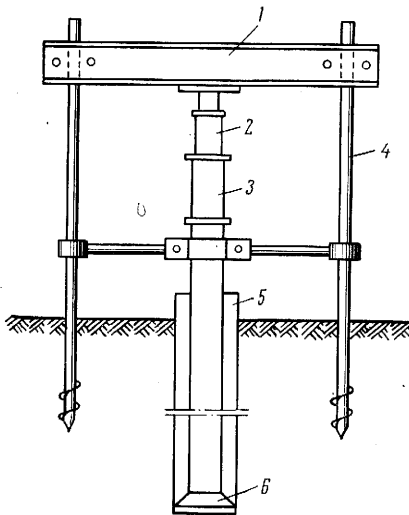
Схема установки для испытания грунтов пробной нагрузкой в скважине:
